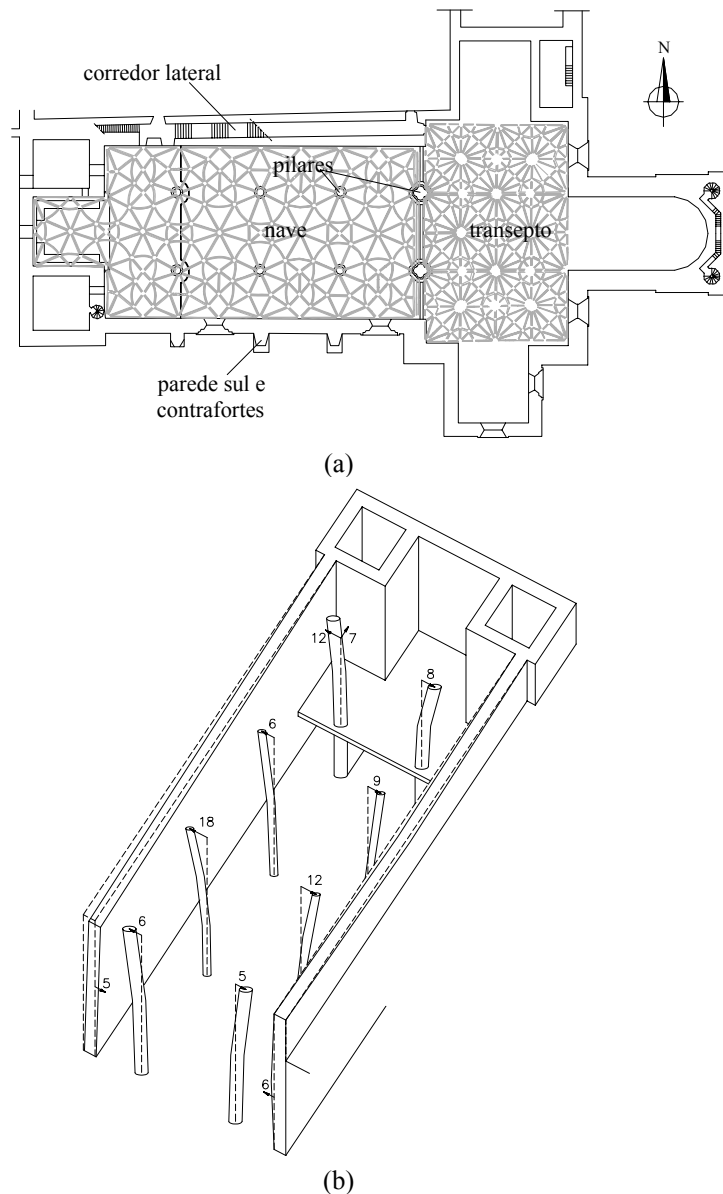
Igreja dos Jerónimos: (a) planta da igreja com a representação das abóbadas da nave e transepto e (b) perspectiva com empeno das paredes e pilares (em cm) na zona da nave [3]
